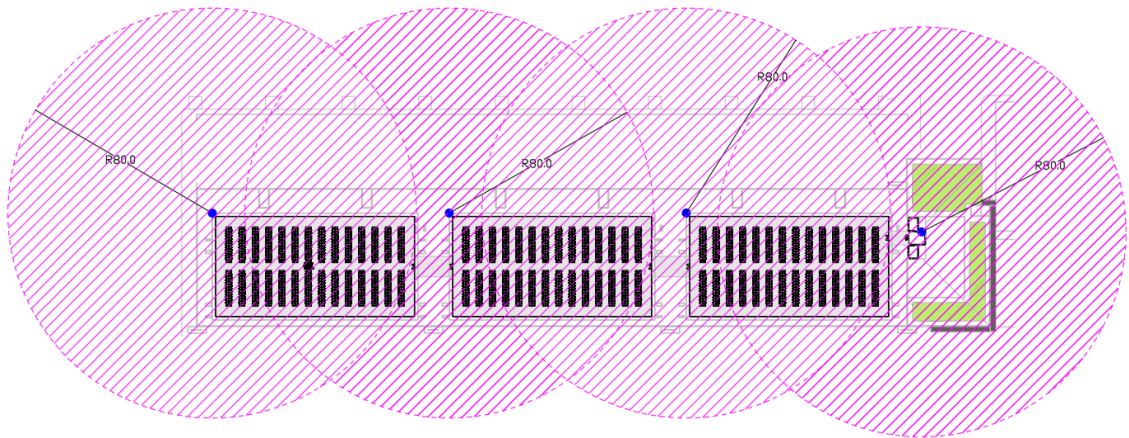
Ilustración 1: Volumen de protección PDC. Vista en planta
